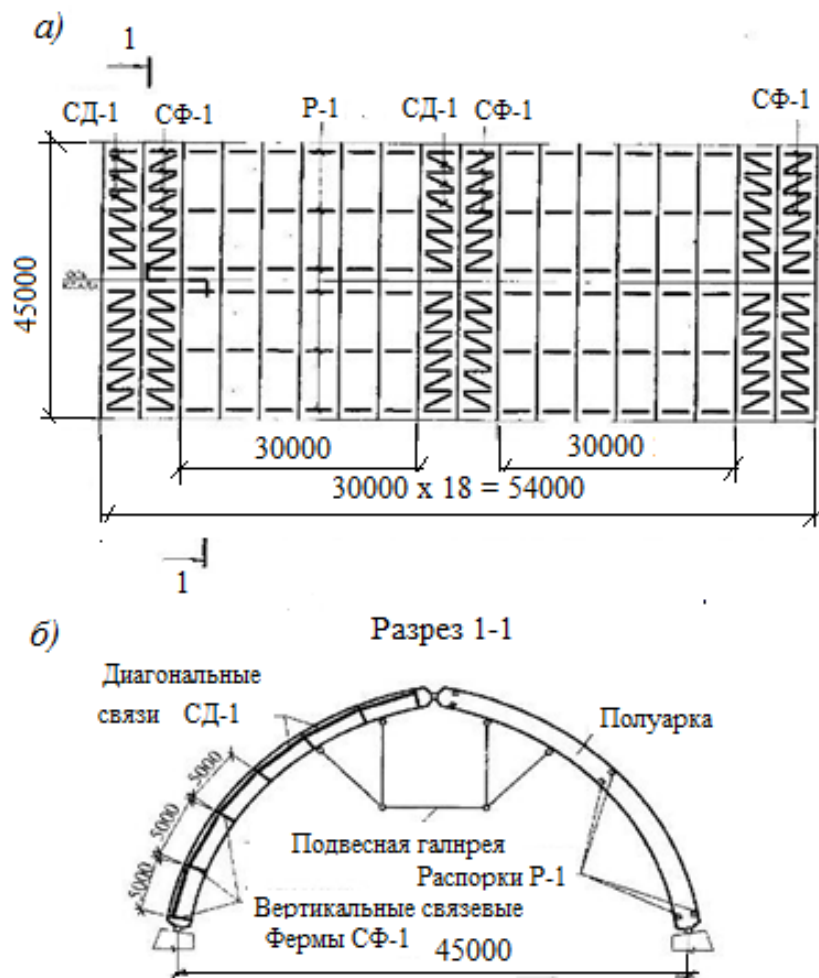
Схема установки связевых блоков и распорок в деревянных несущих конструкциях. а) - схема расположения связей; б) - разрез 1-1
